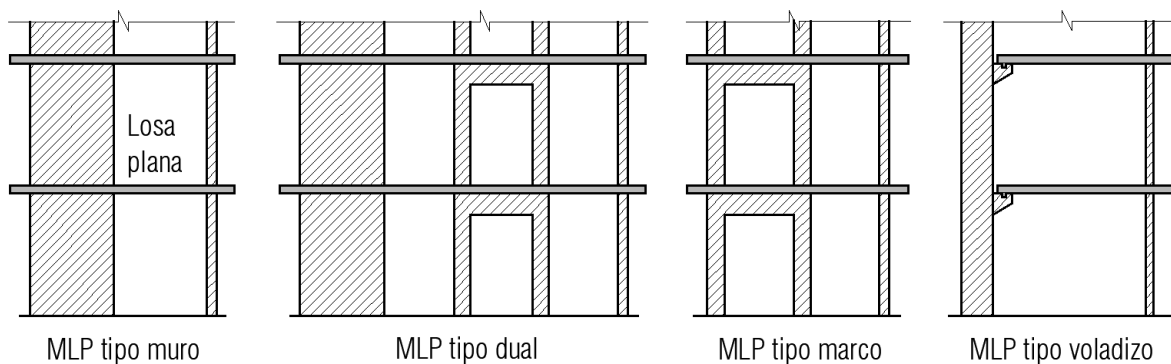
Sistemas estructurales de tipo Mixto con Losa Plana (MLP).
